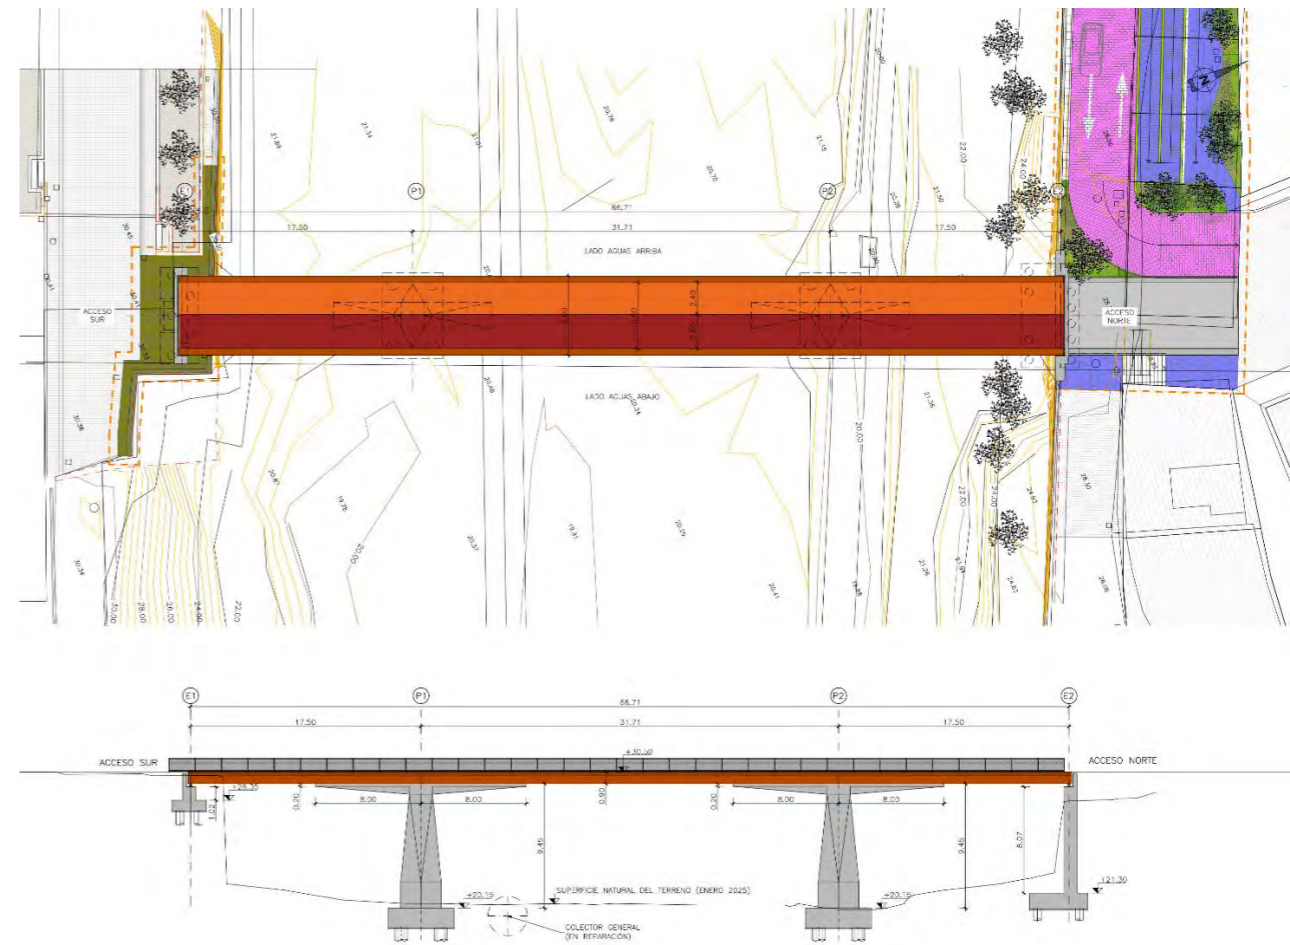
Planta y alzado de la pasarela del poeta Ángel González
